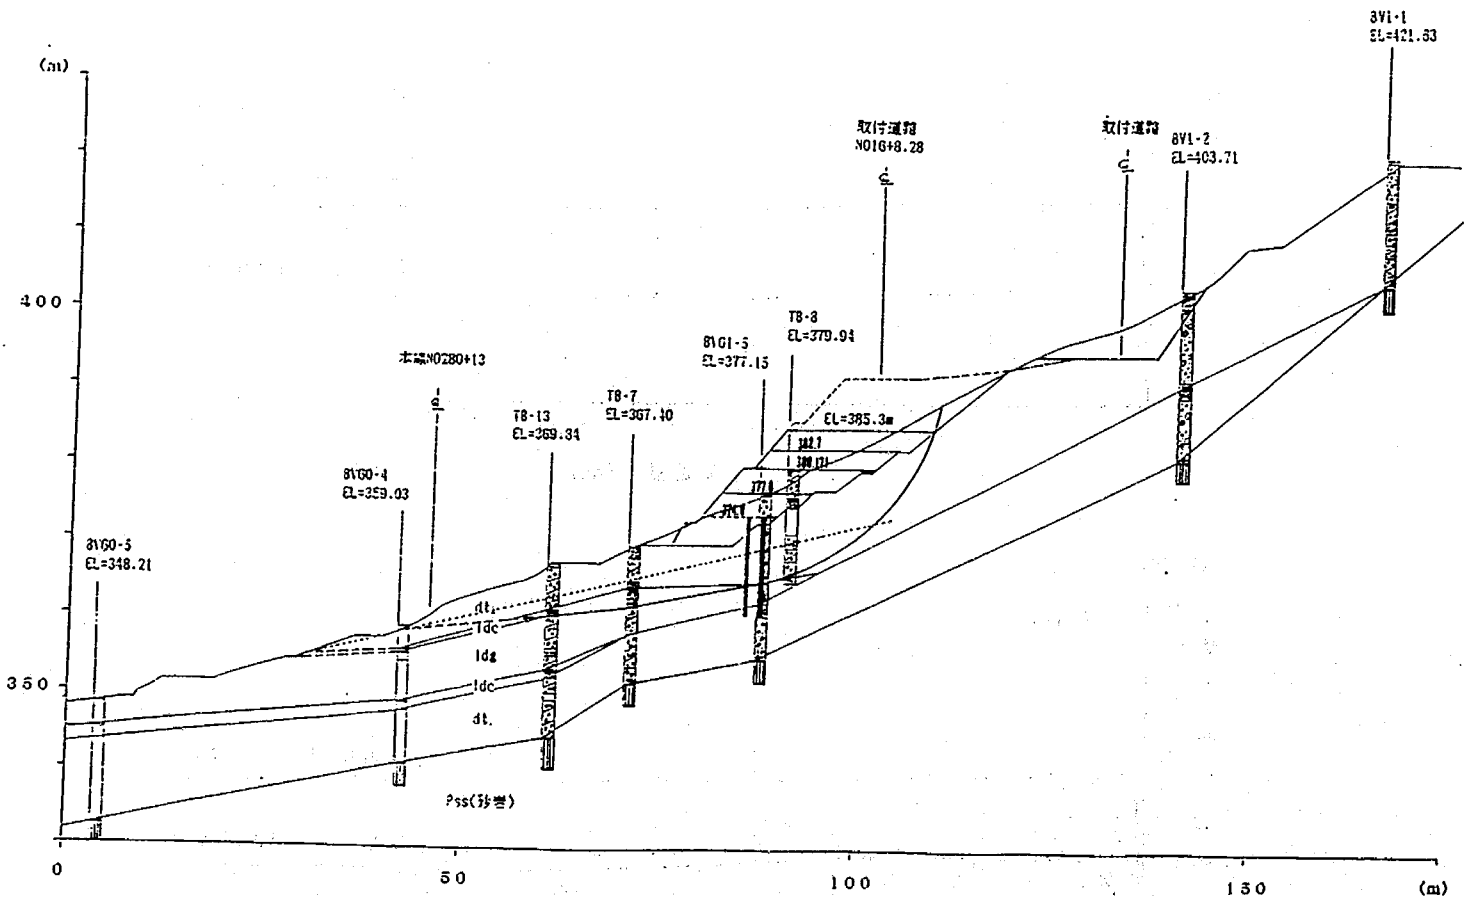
1 安全率の逆算に用いた盛土の施工状況図
